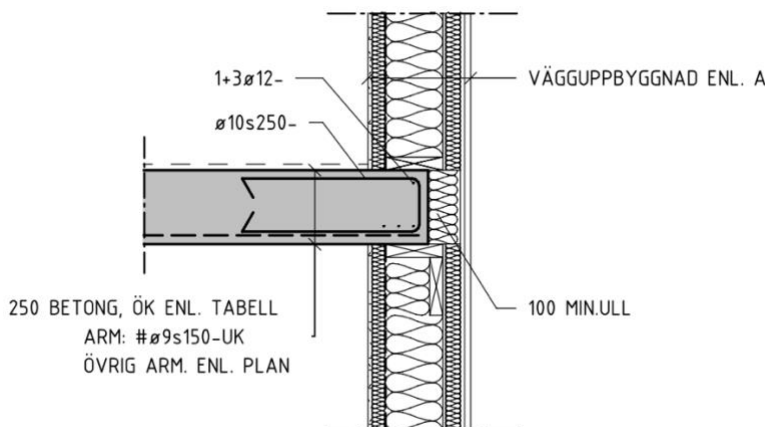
Yttervägg av lättbetong som ansluts till ett mellanbjälklag av betong
